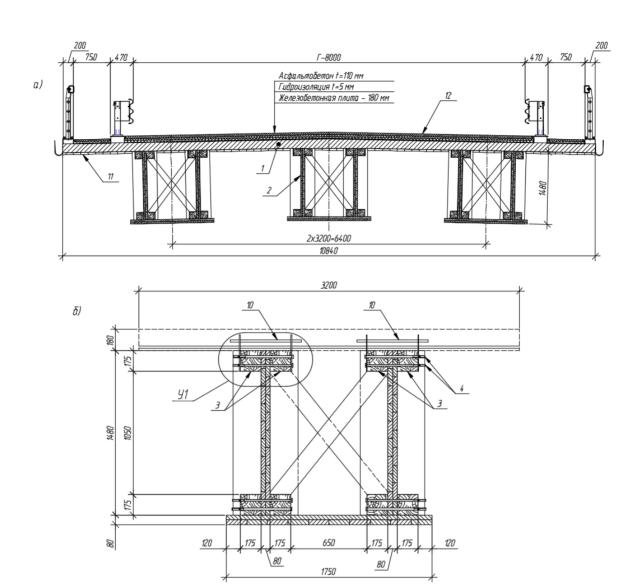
Конструкция комбинированного пролетного строения из дощато-нагельно-гвоздевых блоков и монолитной плиты проезжей части: а — поперечное сечение пролетного строения; б — поперечное сечение блока
